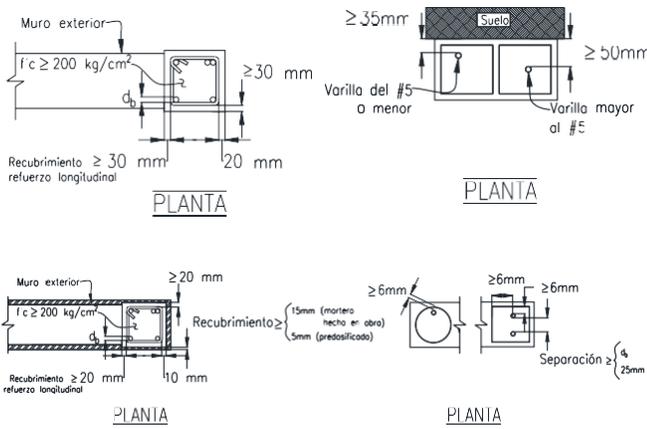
Tamaño, colocación y protección del refuerzo.
